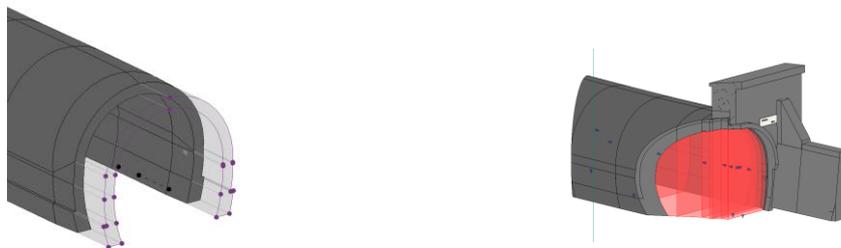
Profildarstellung der Tunnelemente; Luftraum Tunnel im Schnitt
